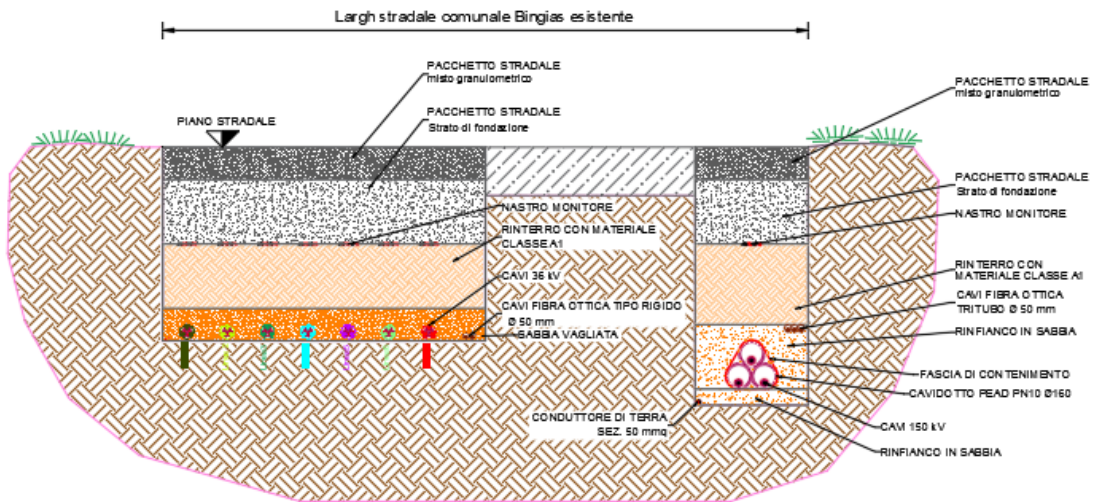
Sezione trasversale parallelismo Cavidotto 36 kV con cavo AT
